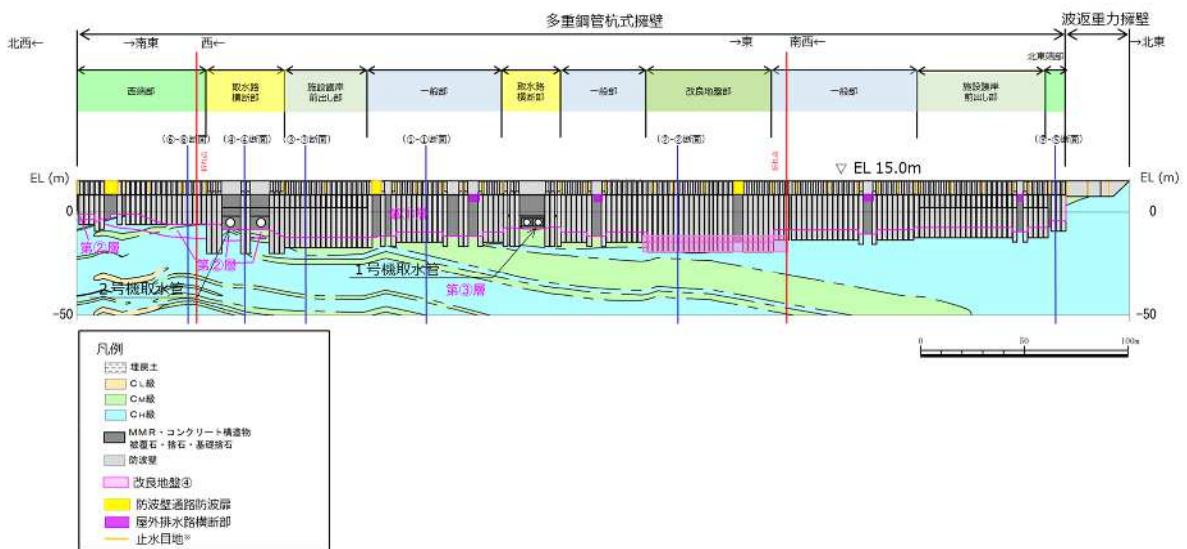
防波壁（多重鋼管杭式擁壁）縦断面図
